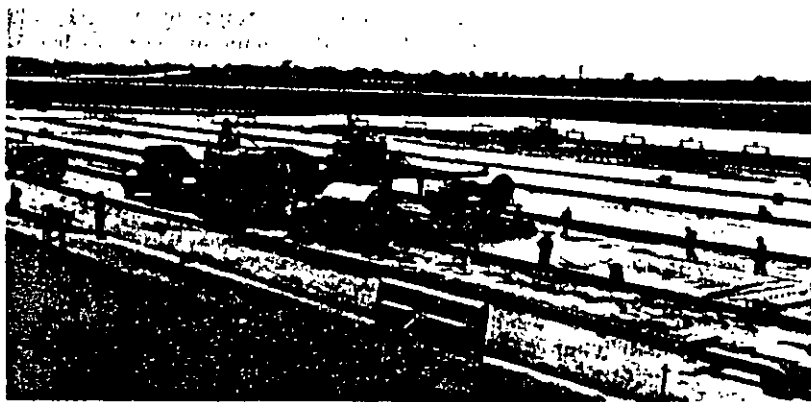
Pavimentación de una pista de carreteo en un aeropuerto con carriles alternos. Los carriles intermedios se pavimentan después de remover las formaletas de los primeros.
